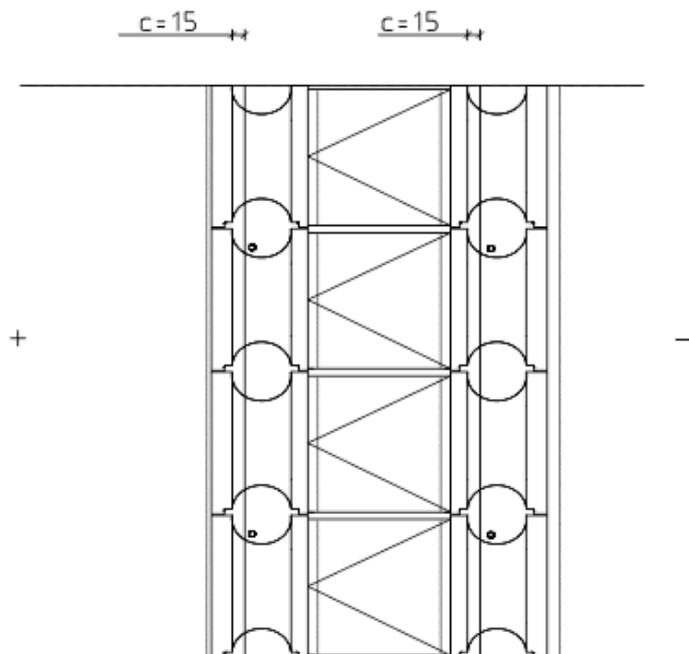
Расположение вертикального армирования в стене с нагрузкой грунта.
